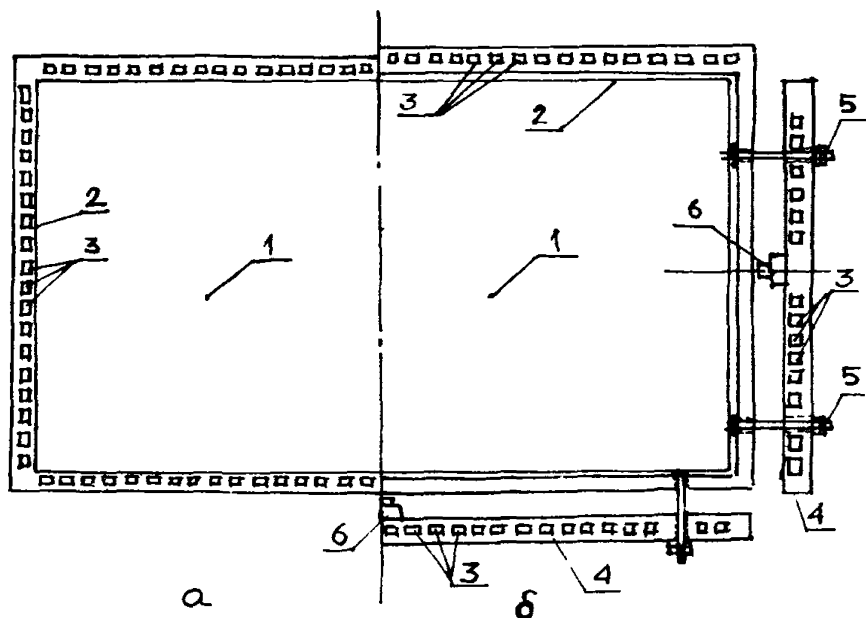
Схема силовой металлоформы для изготовления гибких преднапряженных пластин:
